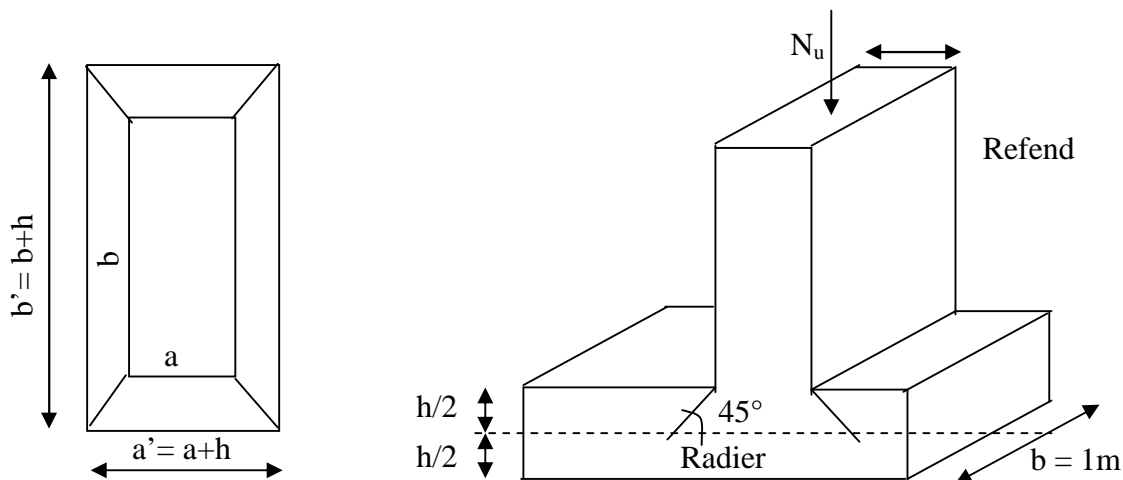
Périmètre utile des voiles et des poteaux.
